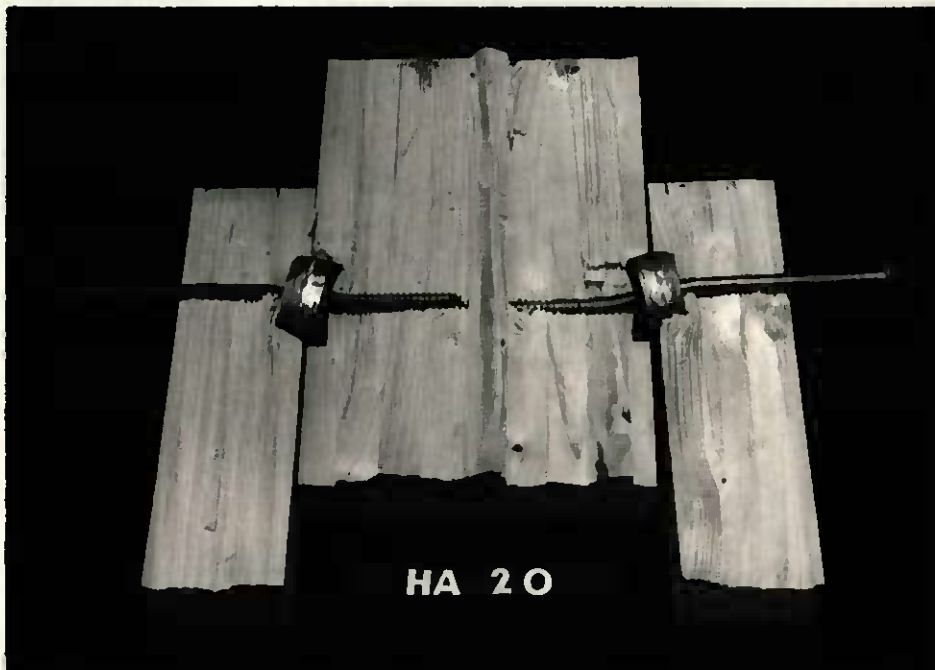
Appel-Verbindung (längs) mit Holzschrauben
